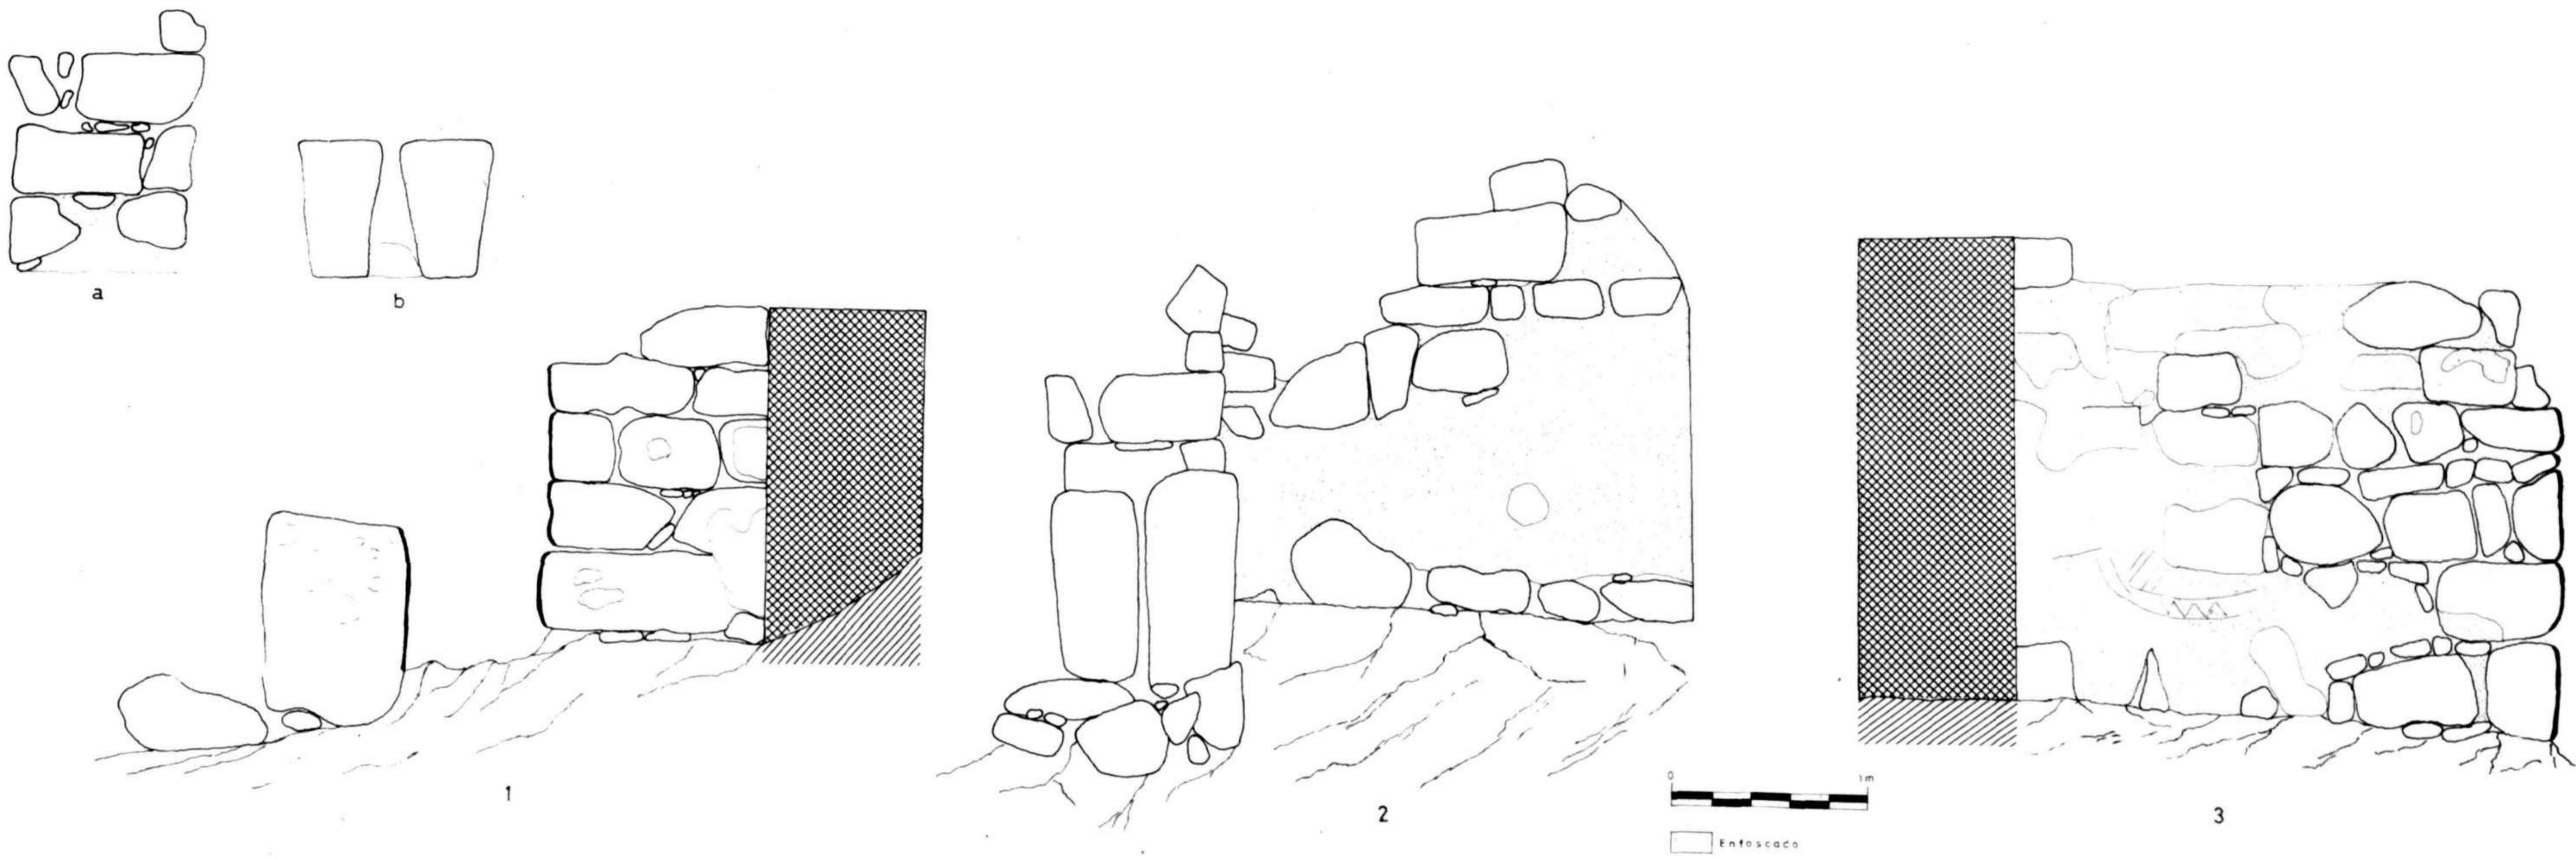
Baño templado, alzado de los muros. 1) muro norte; 2) muro este; 3) muro sur; a: jamba izquierda de la puerta de ingreso; b: jamba derecha.
